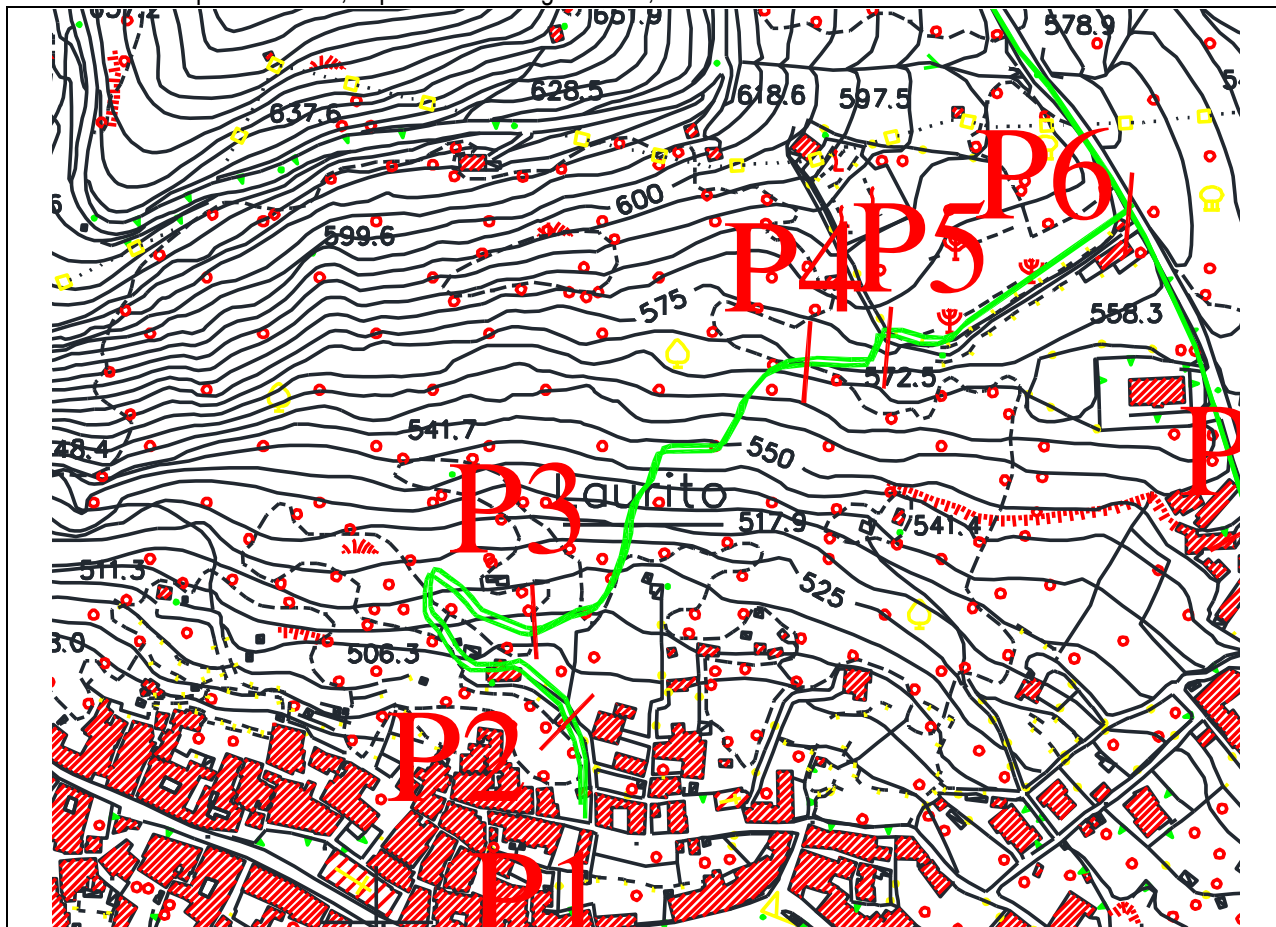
Planimetria Innesso Provinciale - picchetti n° 1-6
